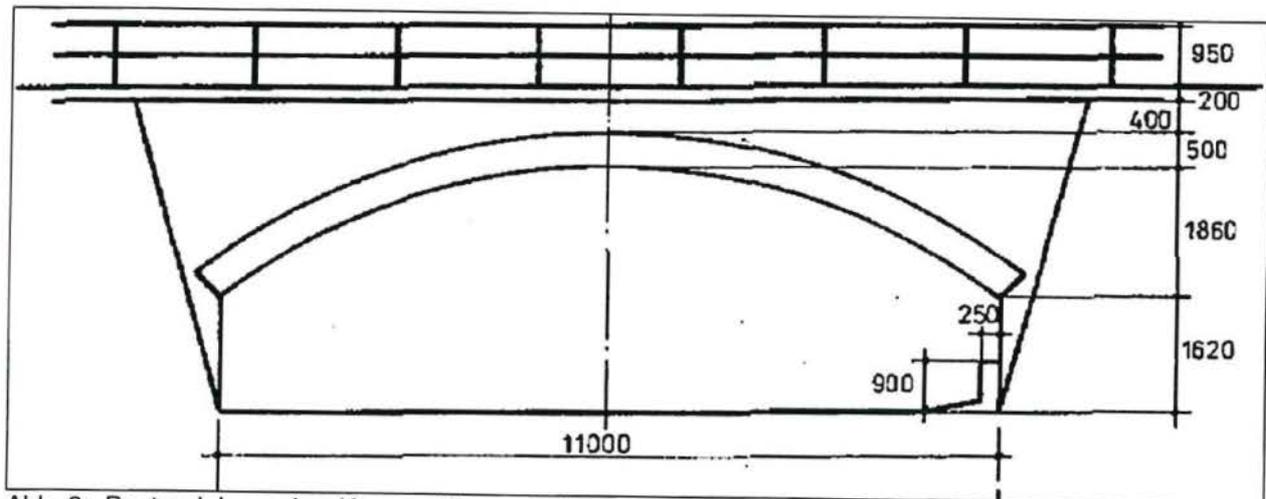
Bestand, Lageplan (Auszug Bauwerksbuch)
